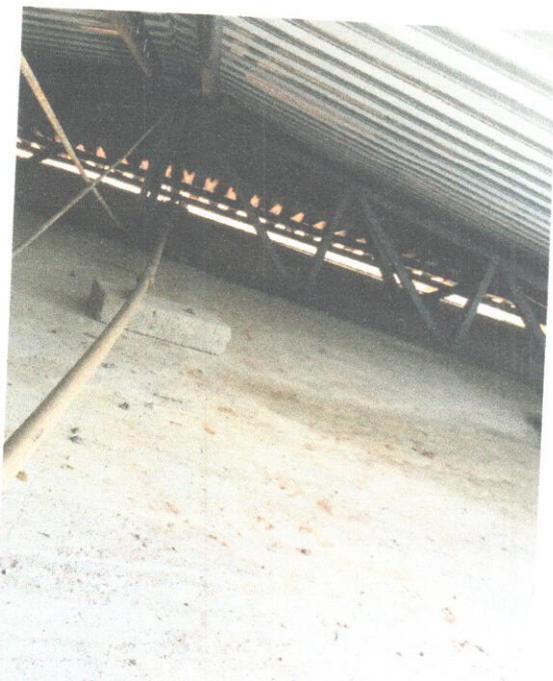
Vista da tesoura metálica devidamente corrigida e montada.
